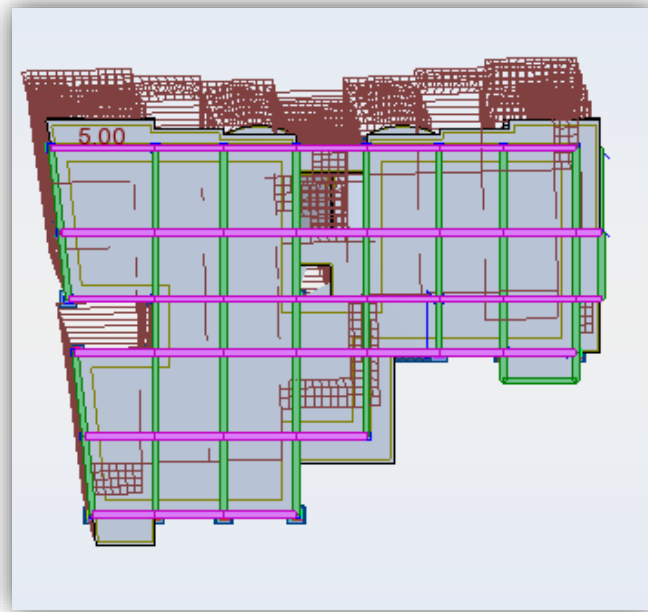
vue en plan du mode 1 translation suivant Y
